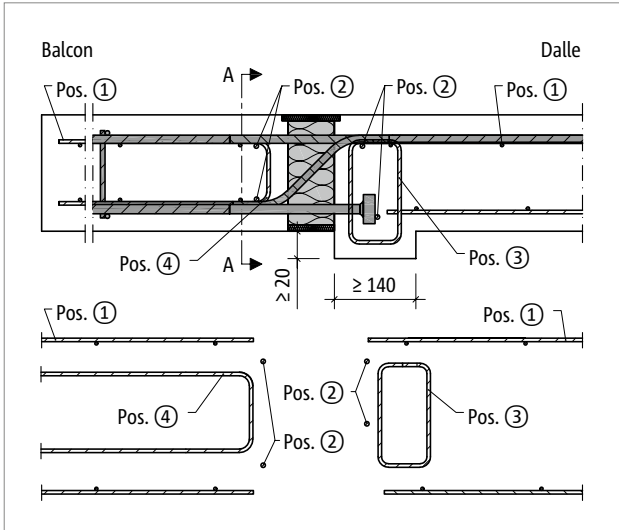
Schöck Isokorb® T type K-T-M13 : renforcement sur site pour support indirect
